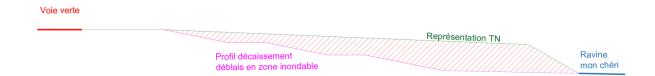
PRINCIPE ENVISAGE DU DECAISSEMENT EN ZONE INONDABLE - PROFIL EN TRAVERS
